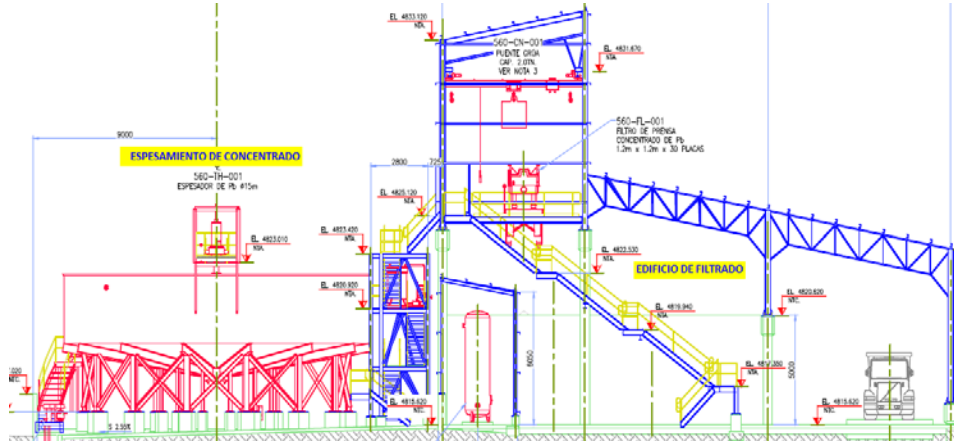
Zona de Espesamiento y Filtrado (Fuente: Empresa consultora ABC)
